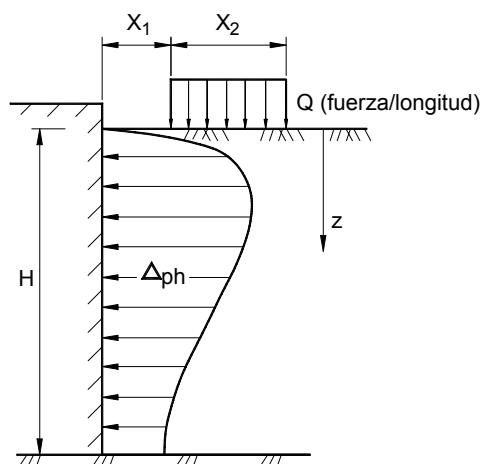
Empuje horizontal sobre un muro provocado por una carga lineal de longitud finita perpendicular al muro
